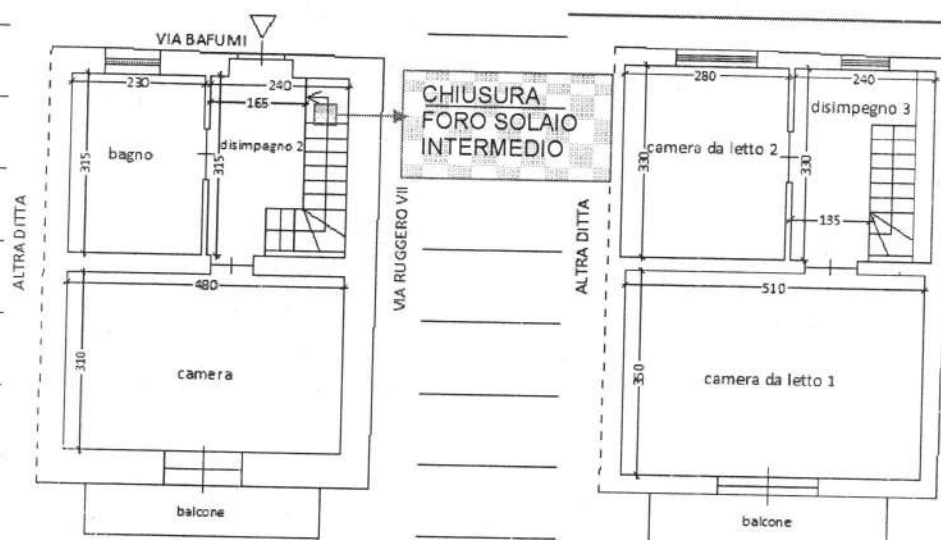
LOTTA A - Pianta piano 1° e 2° STATO DI FATTO
